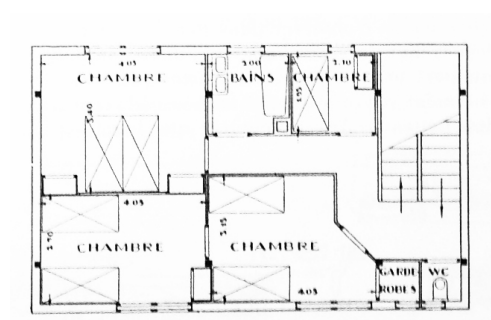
Planta de um casa tipo Dom-Ino.
